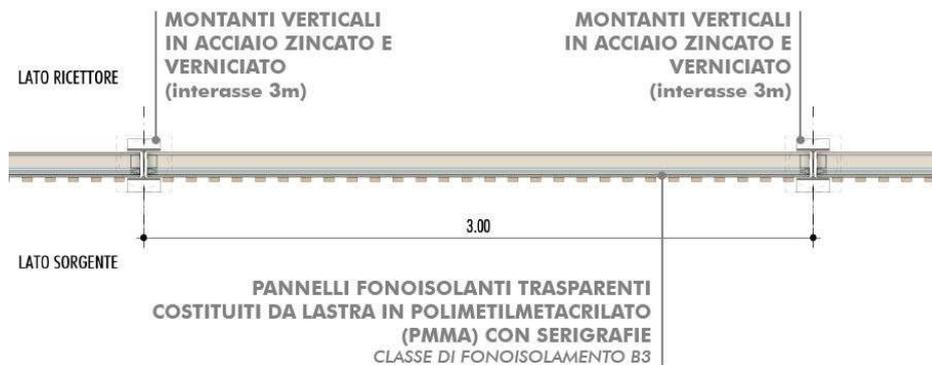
SEZIONE ORIZZONTALE – PANNELLO TRASPARENTE
